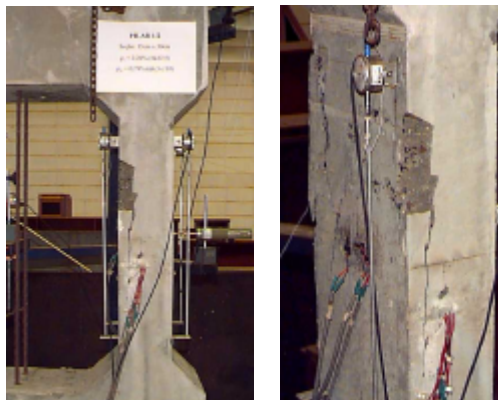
Forma de ruptura do pilar P1/2
